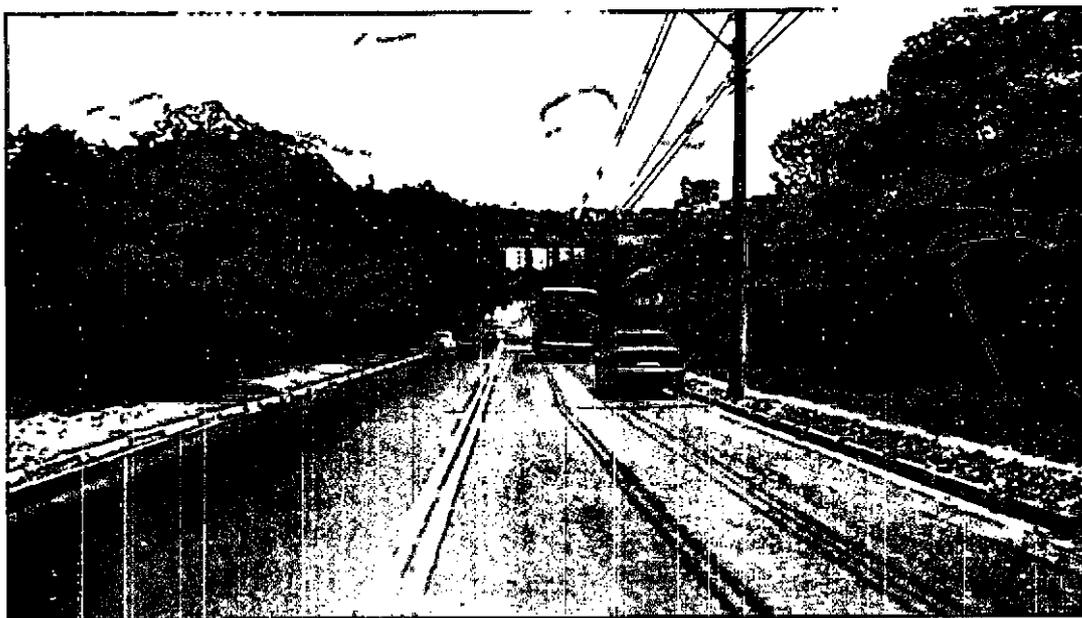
Pavimentação e calçamento existentes na Avenida Remo Oscar Beseggio.
